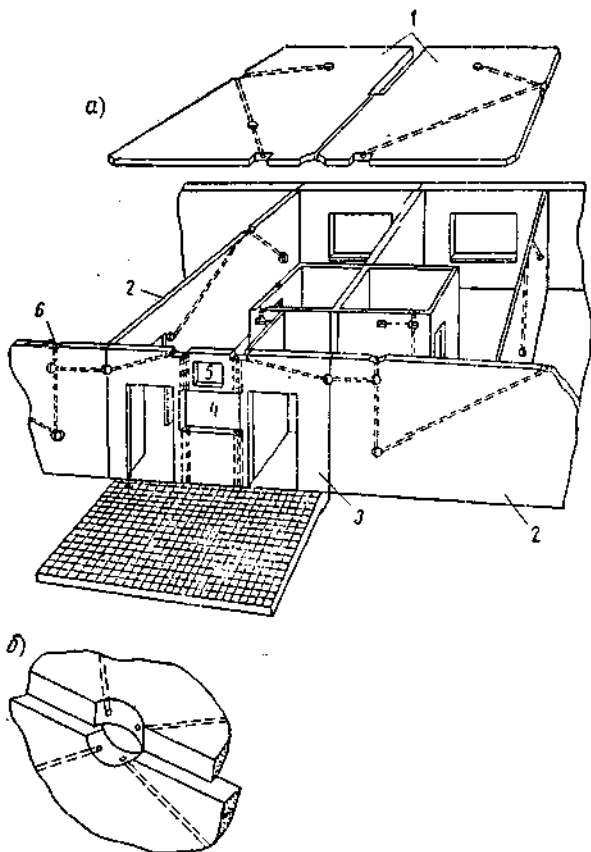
Фрагмент квартиры крупнопанельного жилого дома с каналами для электропроводки в панелях стен и перекрытий
